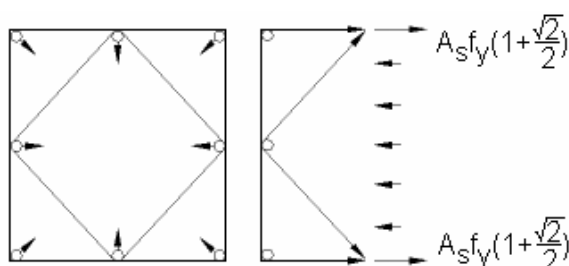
Determinarea efortului de confinare pentru o secțiune de beton dreptunghiulară
